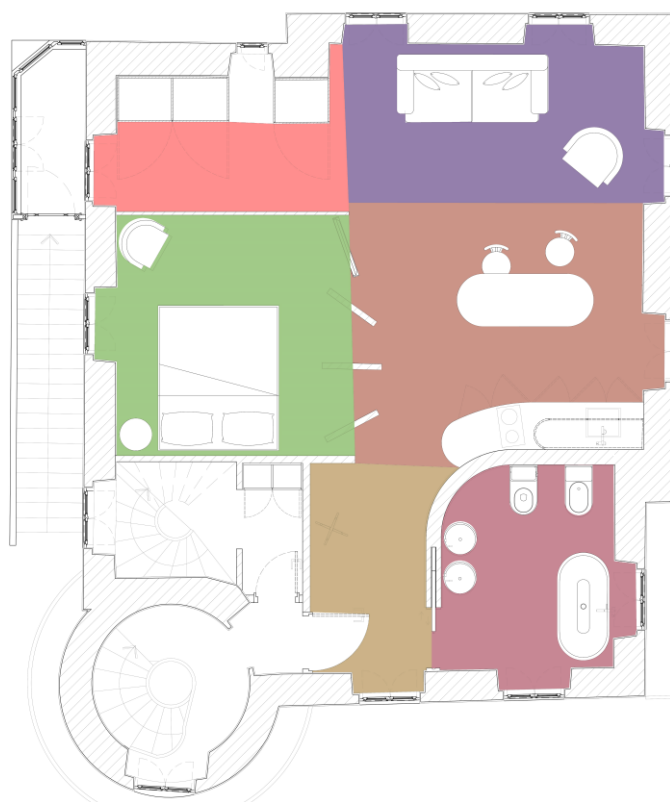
Planta de Zonamentos, Estúdio D. Manuel I- Piso 1 ; Fonte: Beatriz Cordeiro
